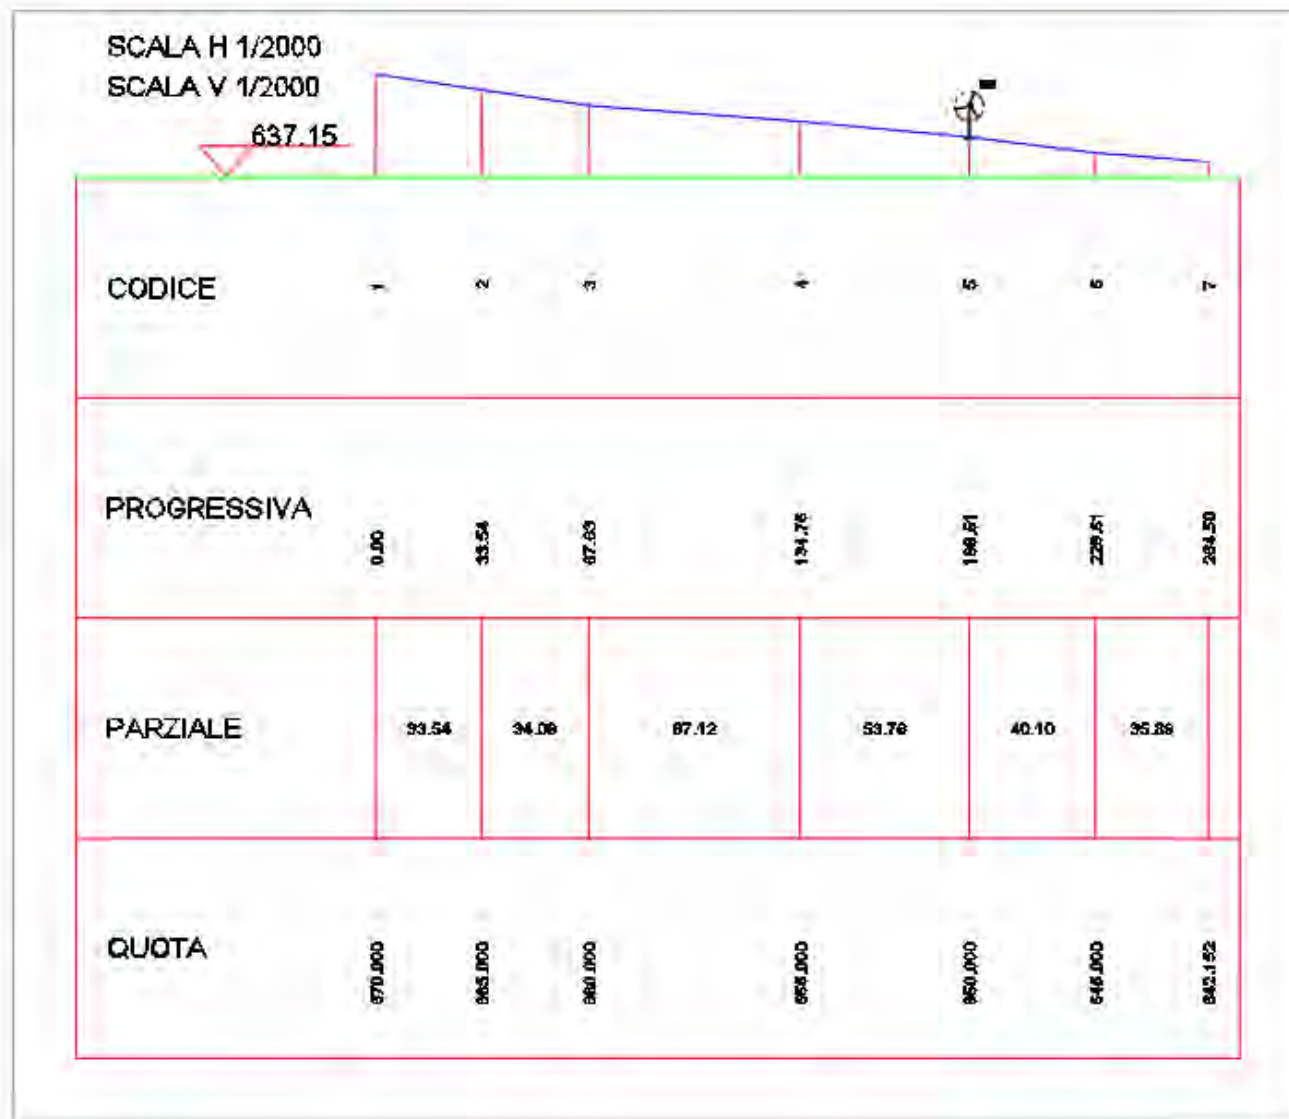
Profilo Sezione E-E' e ubicazione generatore di progetto BV1
